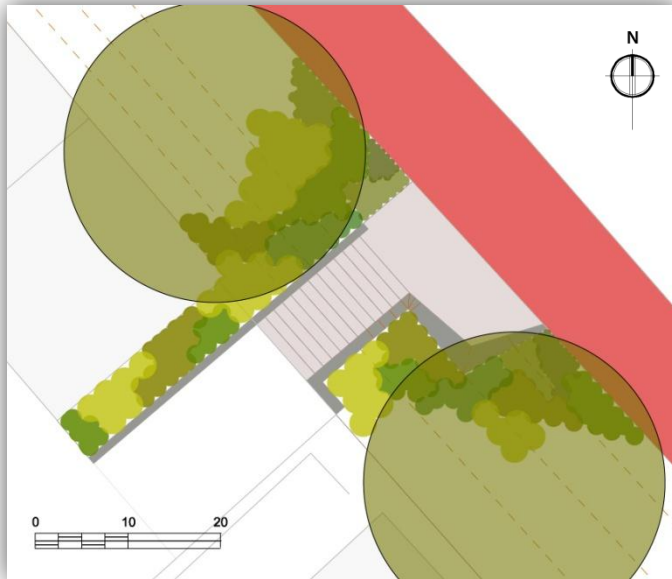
Planta da proposta do acesso A1 do Bairro Zona de Urbanização nº3
